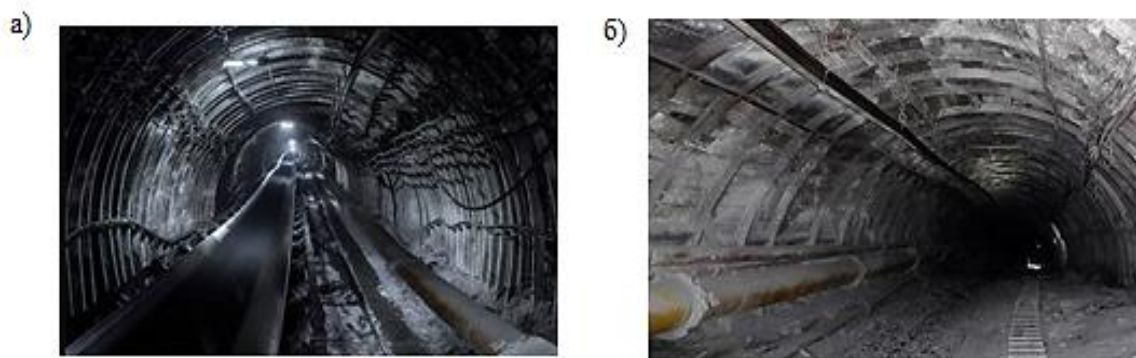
Типові схеми кріплення трубопроводу в підземних виробках:
